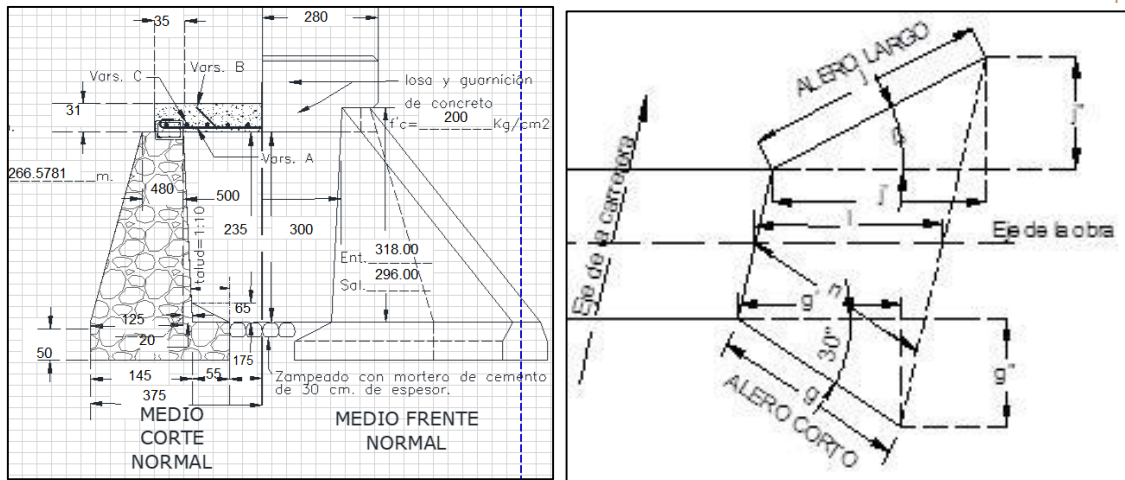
Ejemplo de zampeado y construcción de aleros
